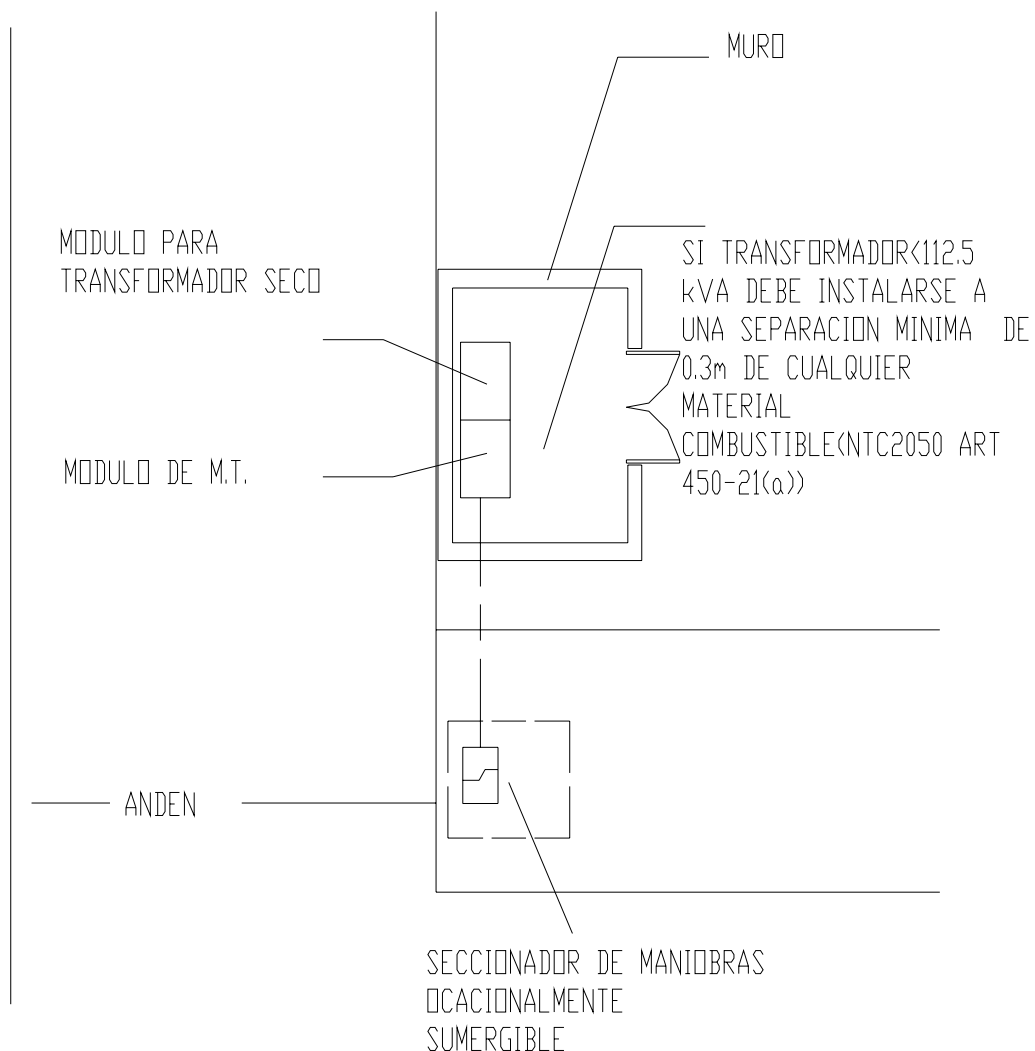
Vista de planta subestación con seccionador fuera del local.
